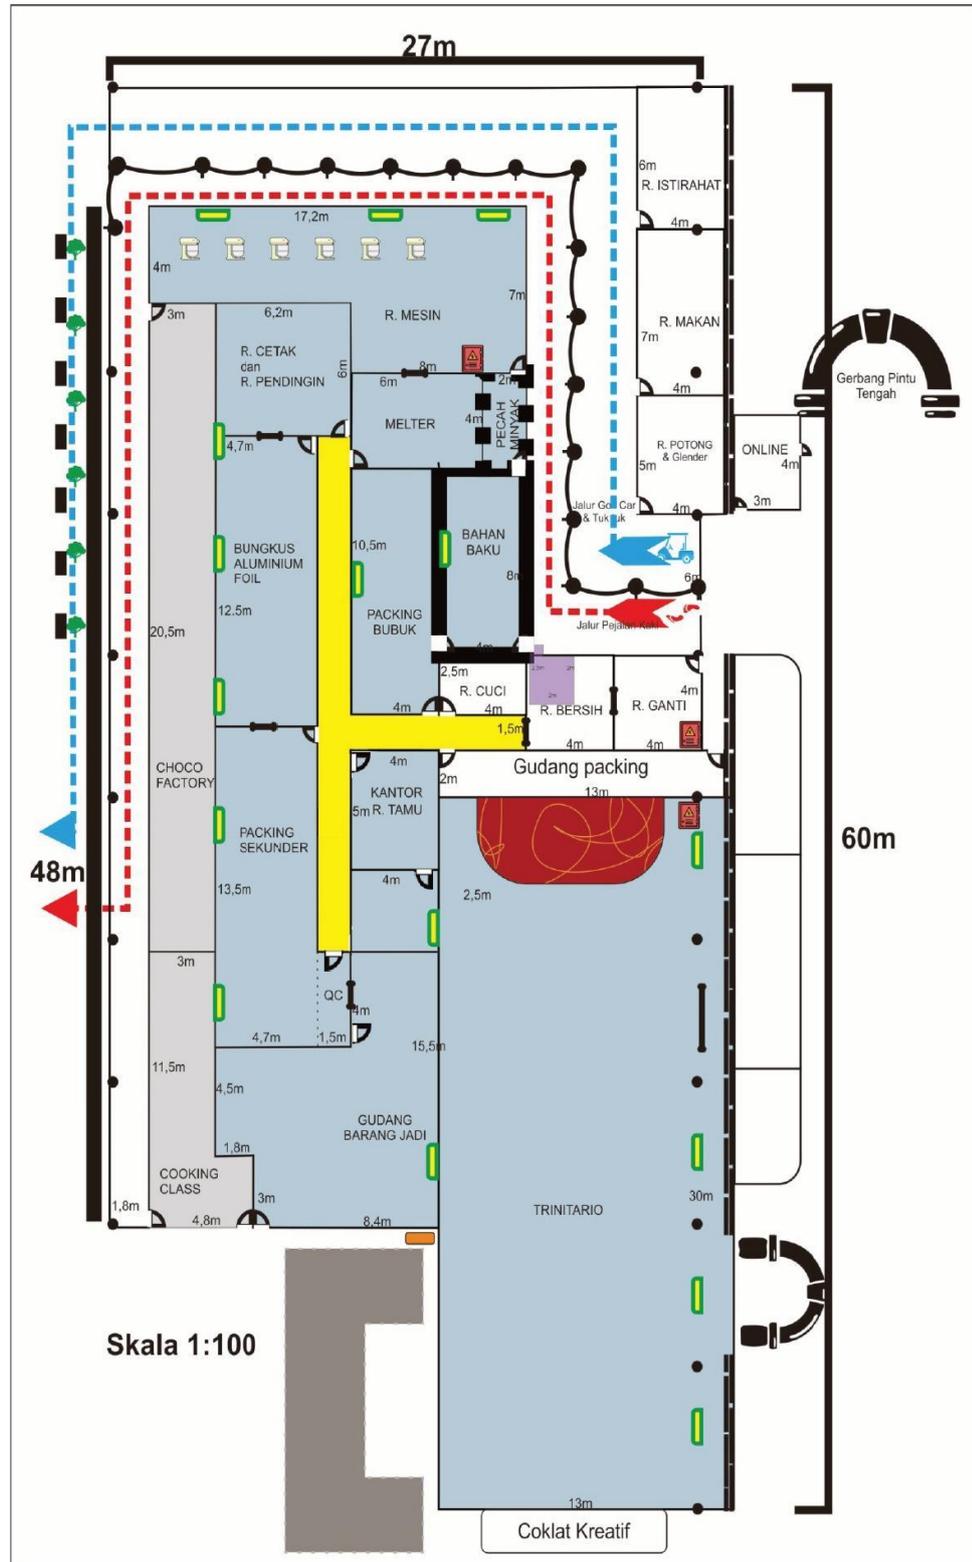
Denah Lokasi PT. Kampung Cokelat Blitar
